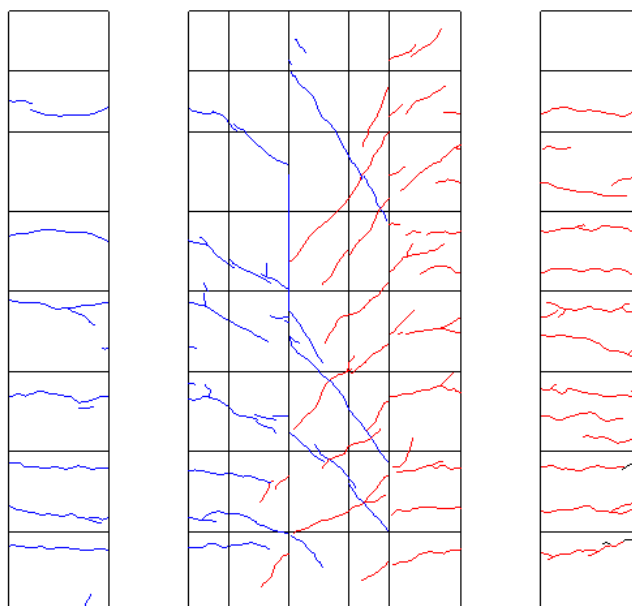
R=-1/200 ひび割れ図
